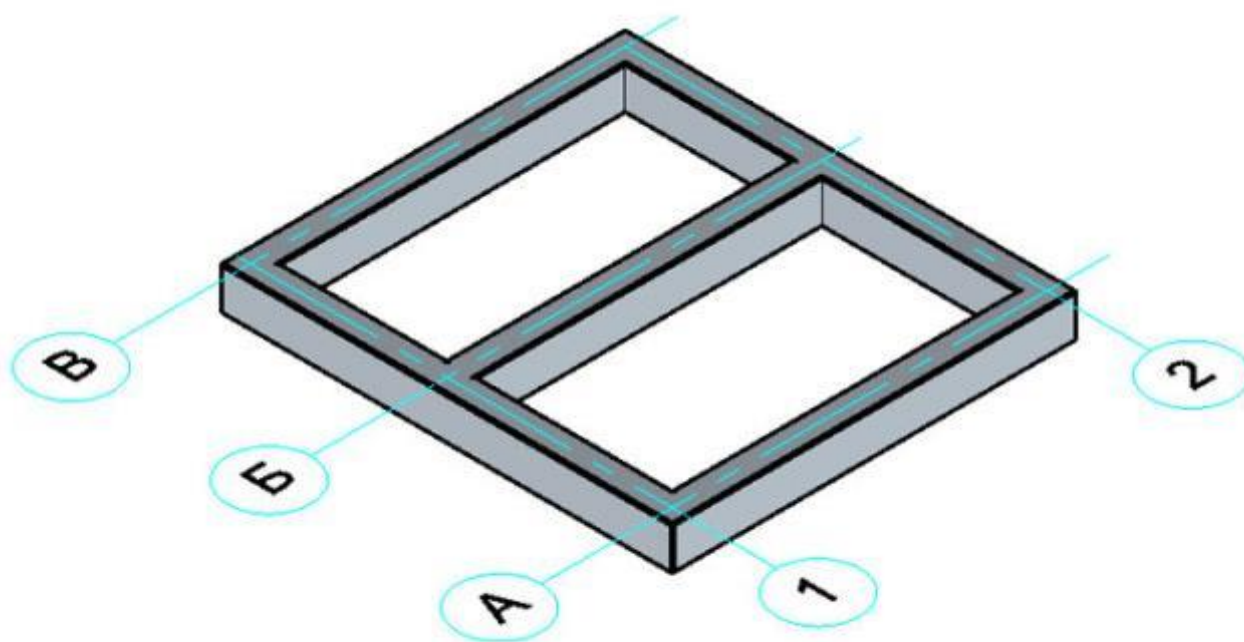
Исходные данные для проектирования ленточного фундамента: А, Б, В, 1, 2 – расположение несущих стен здания.
